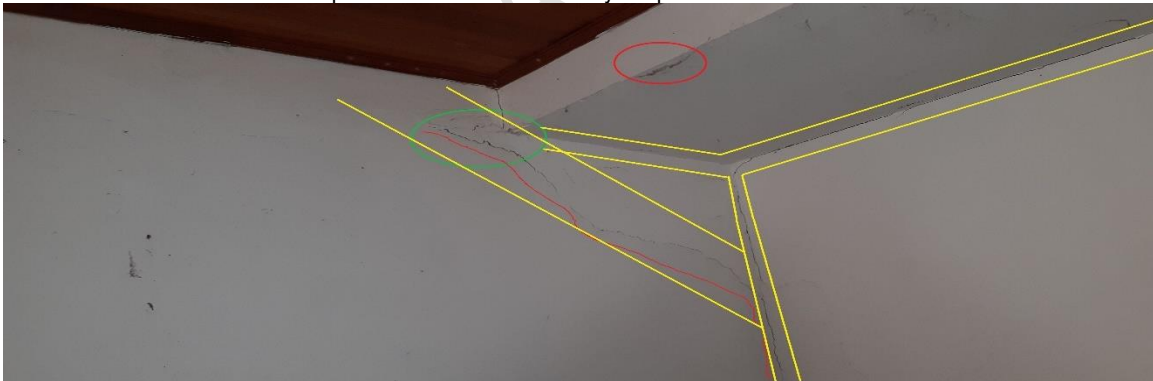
Grietas en sentidos horizontales, verticales y diagonales en muros y losas, para este caso es necesario confinar los muros, (columnetas en concreto reforzado), para brindar mayor estabilidad a la estructura de la misma.
